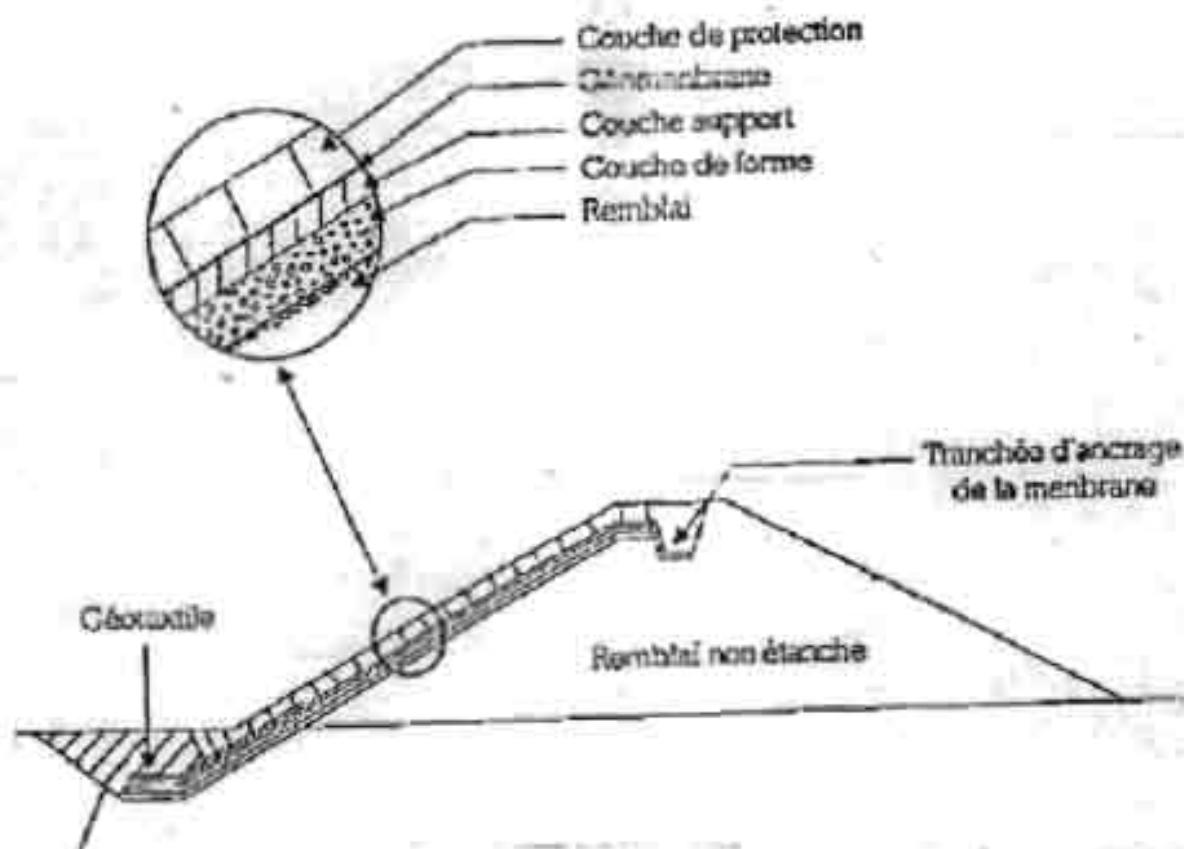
Exemple de barrage en remblai non étanche muni d'un dispositif d'étanchéité par géomembrane avec ancrage au pied dans une clef d'étanchéité
